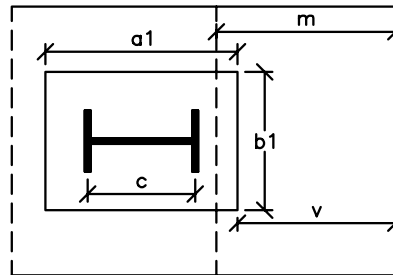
Vuelo de cálculo en una zapata con pilar metálico.
